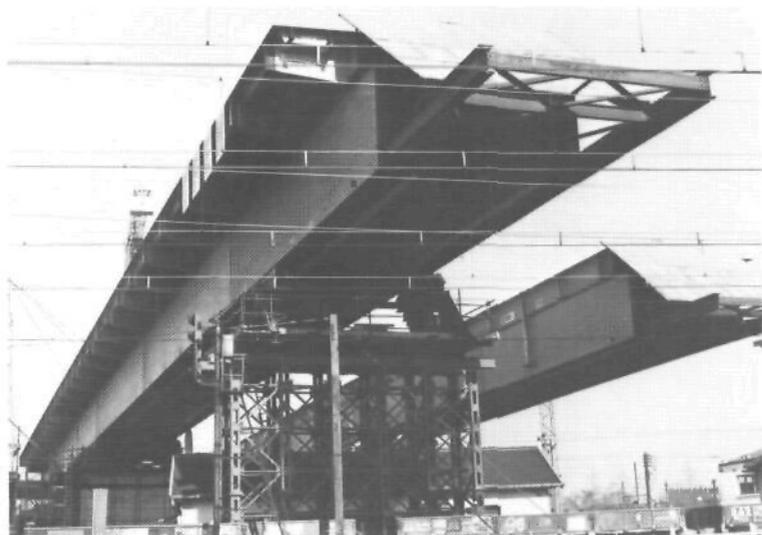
Selle d'appui équipée en partie inférieure de son cadre de relevage posé sur quatre vérins.
